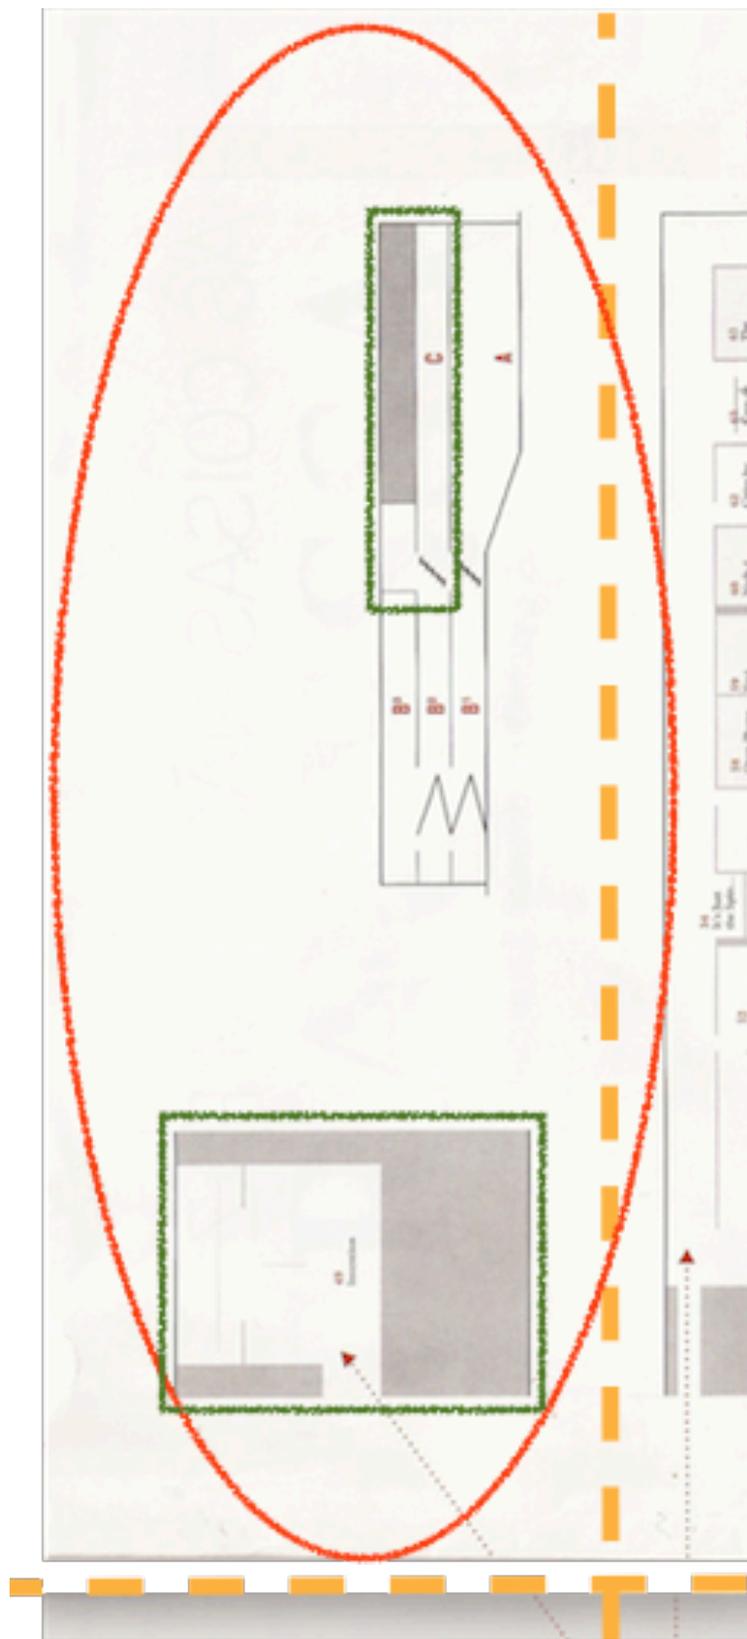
Detalhe do mapa da exposição Planta Invention e Planta de corte – canto superior direito – à esquerda, planta baixa (PB) de *Invention*; à direita, planta de corte (PC). As áreas com retângulo em verde indicam o local da obra *Invention
